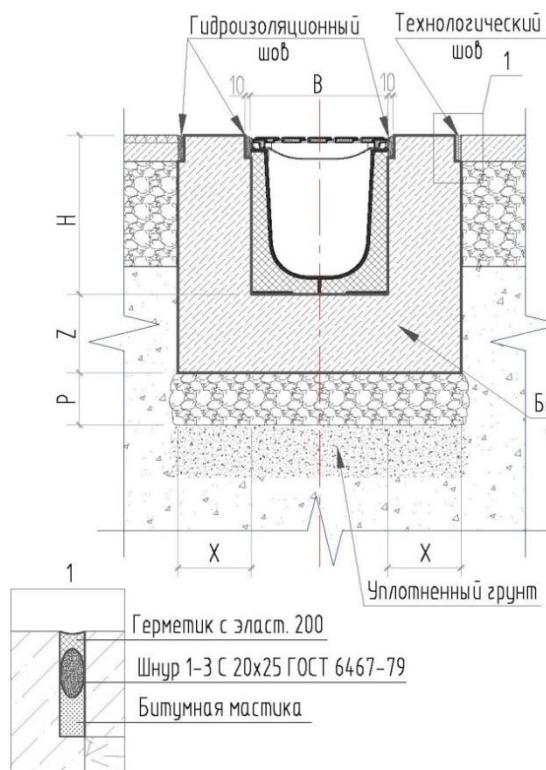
а – Устройство бетонной обоймы лотка с покрытием асфальтобетонным и бетонным для классов нагрузки от С250 до Е600.
